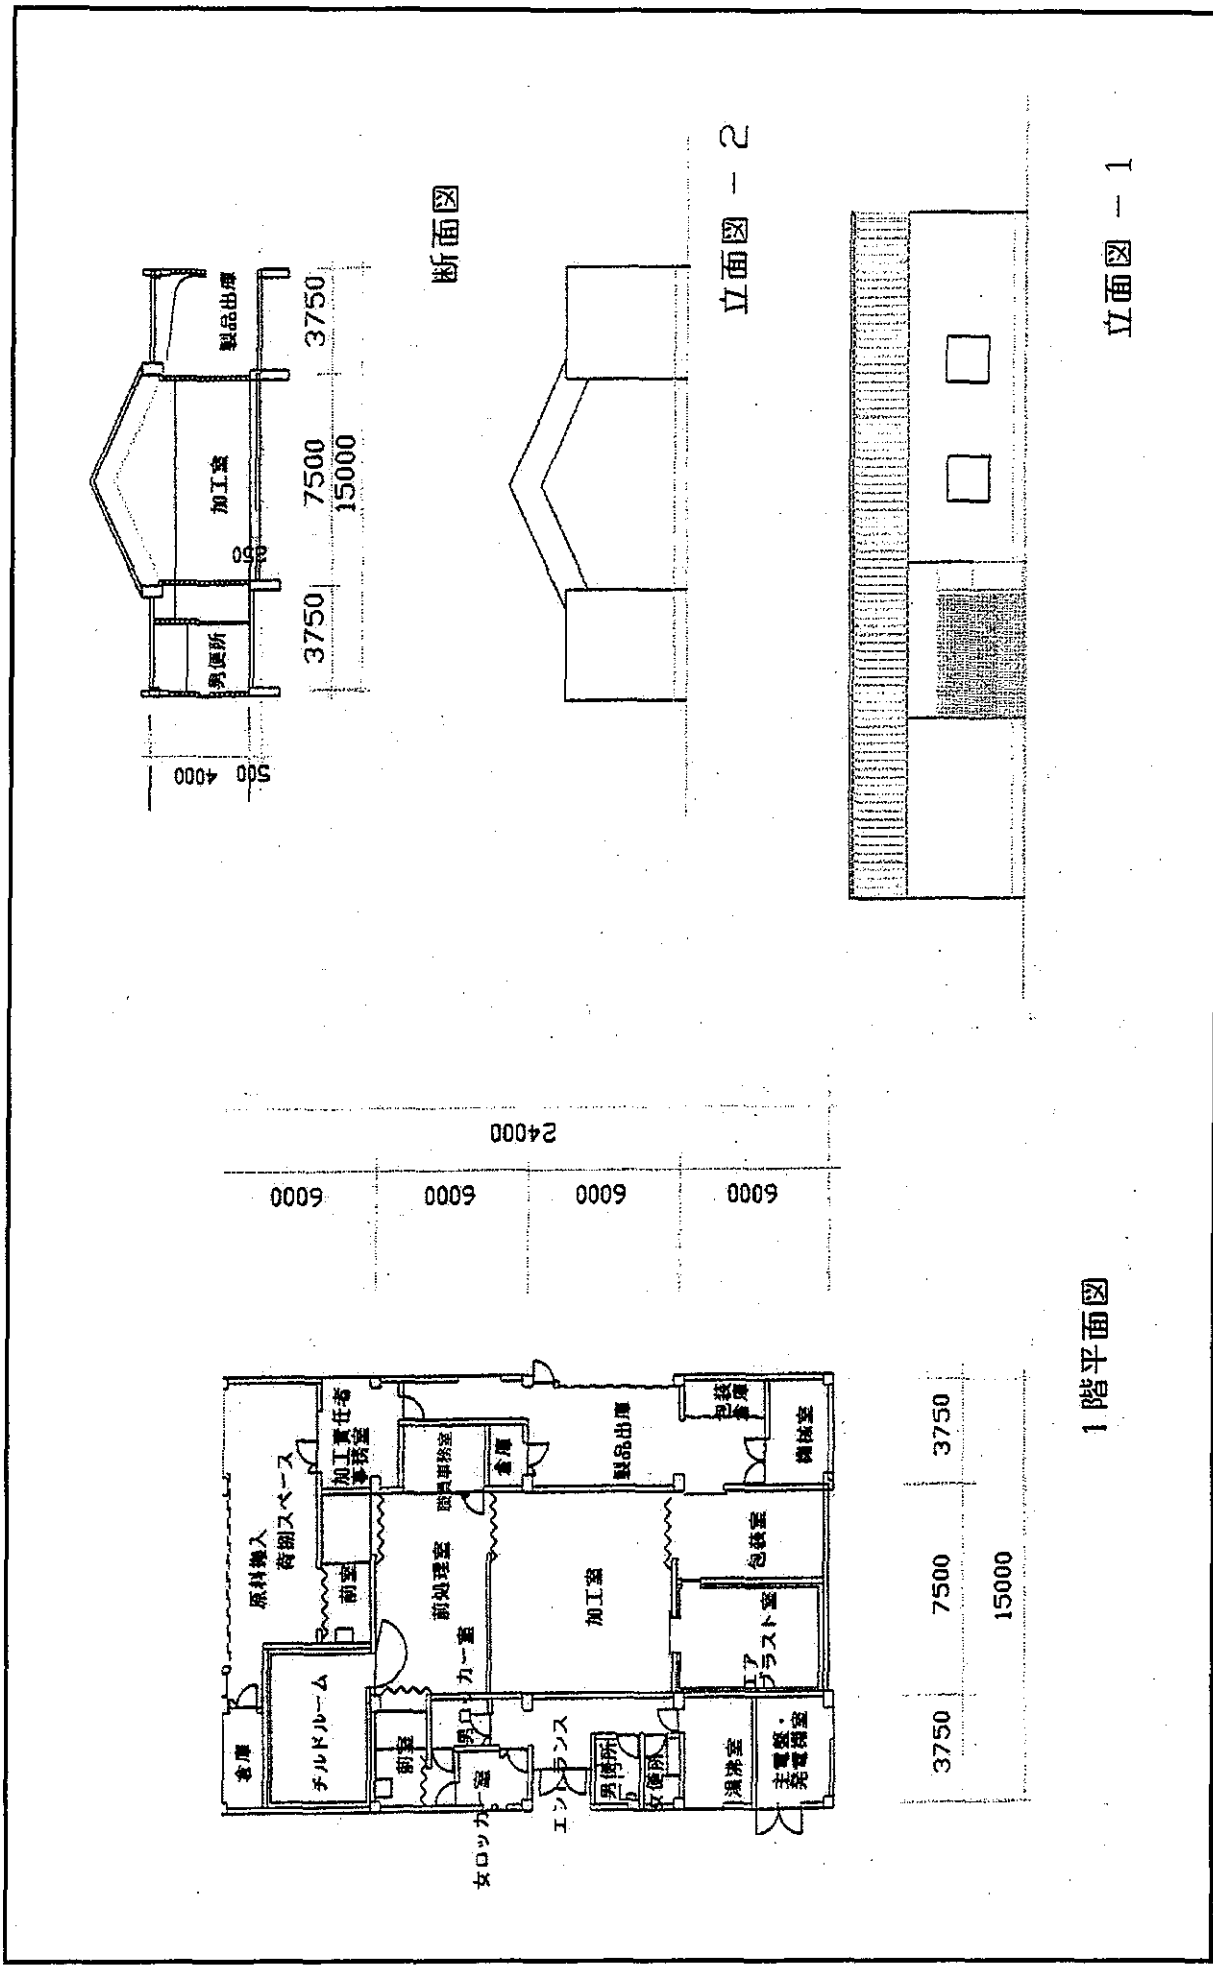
(9) 水産加工場棟平面図・立面図・断面図
